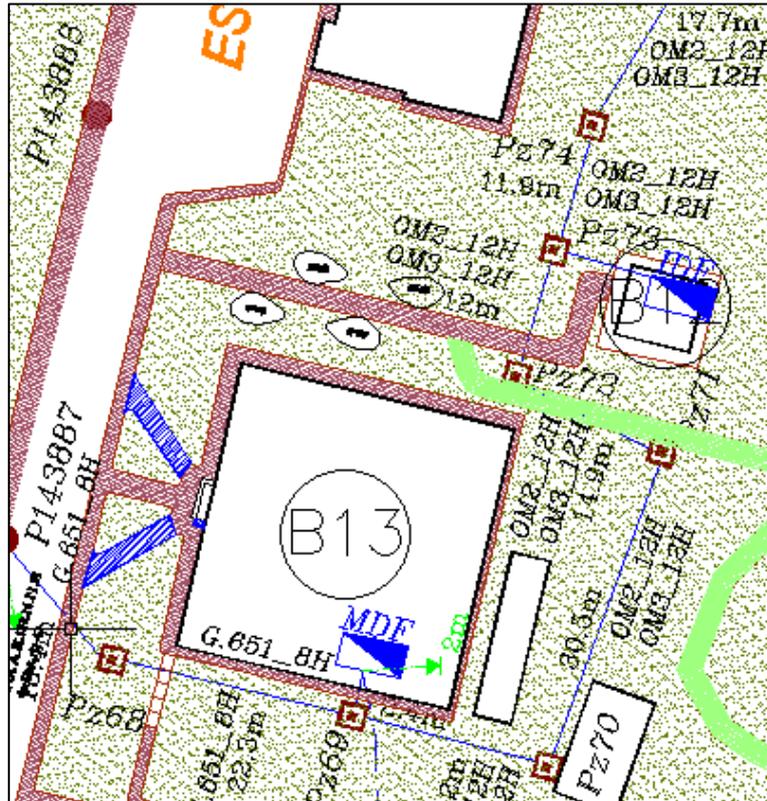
Planimetría del recorrido de fibra óptica existente bloques 12 y 13. (Autor, s.f.)
